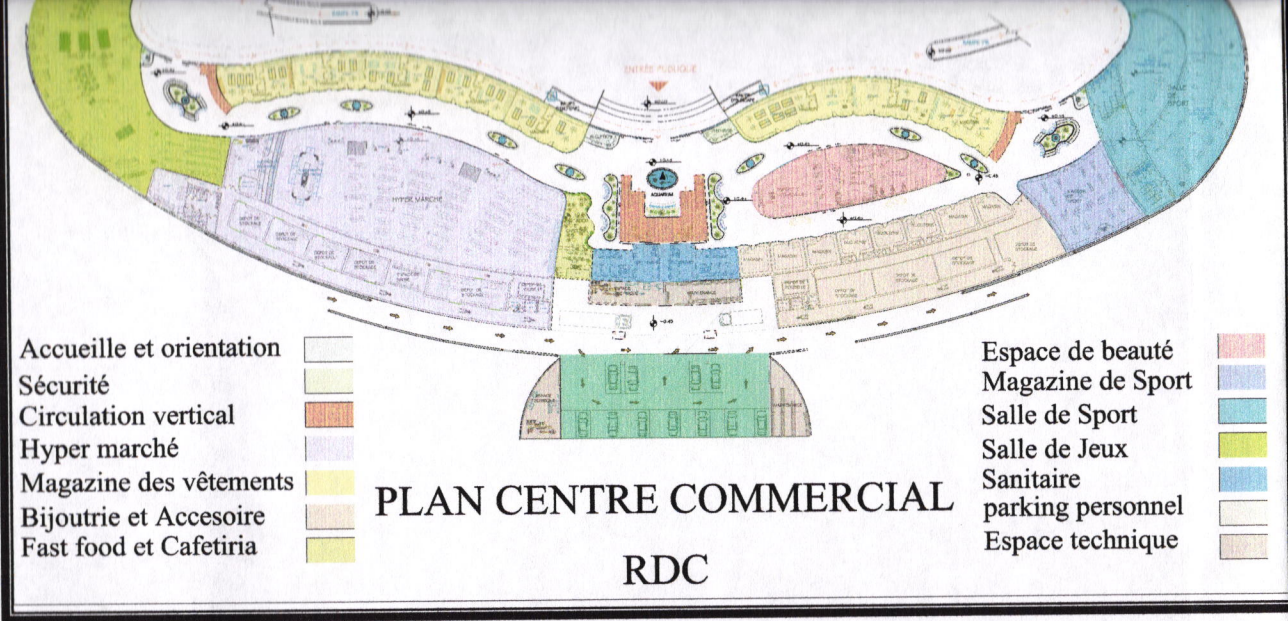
PLAN CENTRE COMMERCIAL RDC
